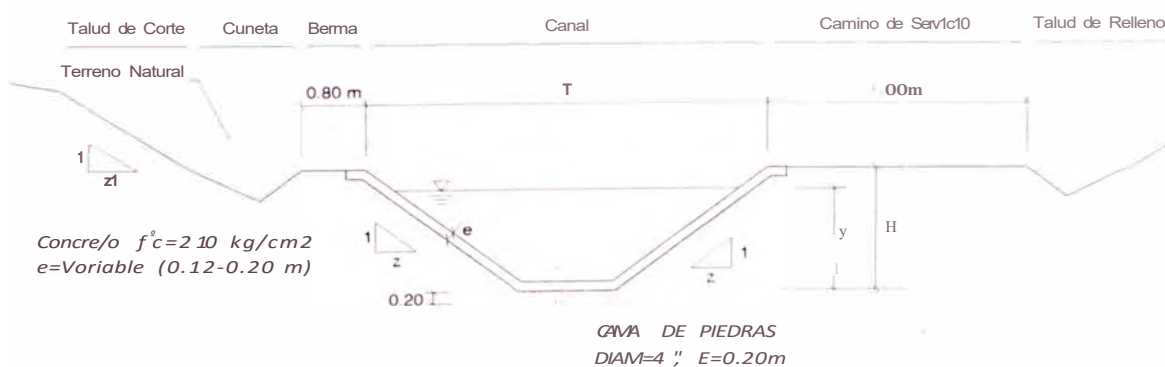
Sección Típica de Cama de Piedras en Corte del Terreno en el Canal Trapezoidal
